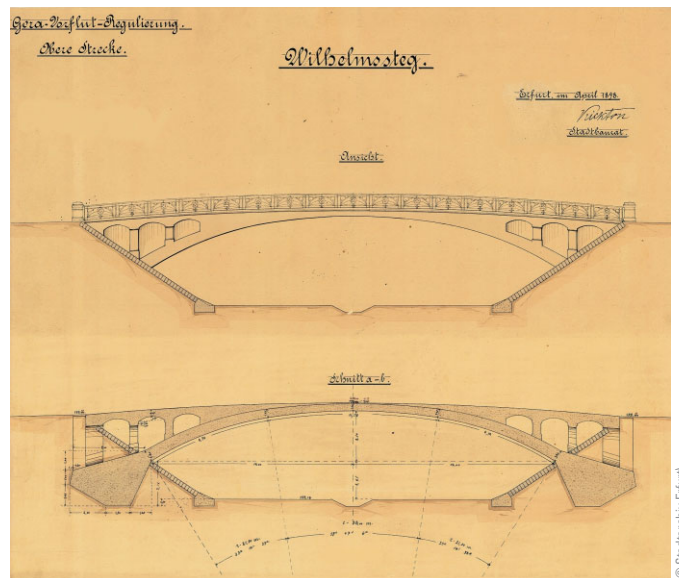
Wilhelmssteg – Bauwerksplan – HERMANN KICKTON – 1898
